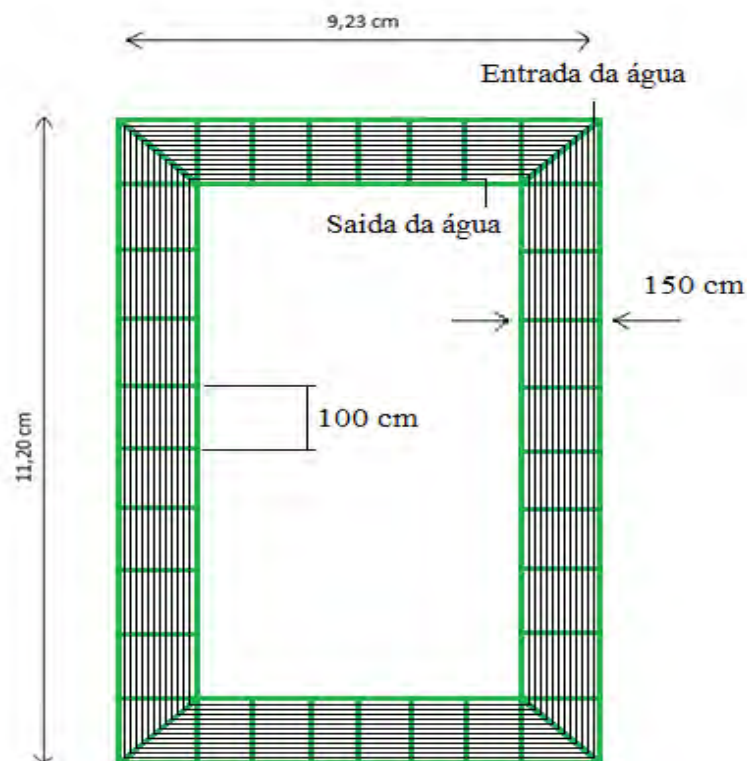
Planta baixa do coletor solar (com as mangueiras de polietileno).
